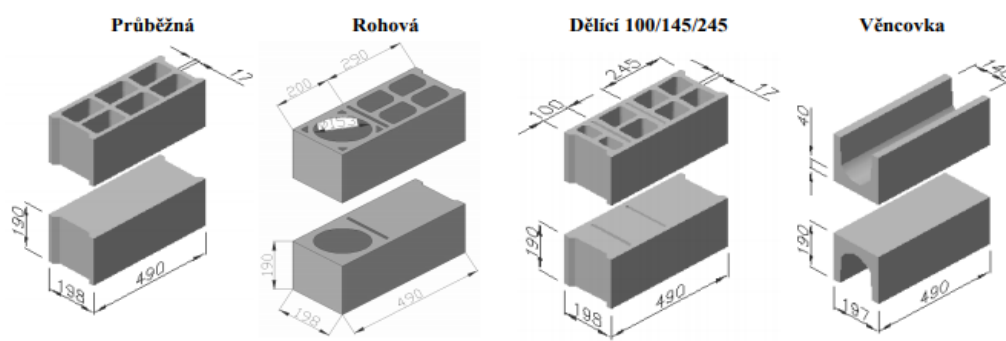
Tvárnice Betong 10 a Betong 15 [29]
